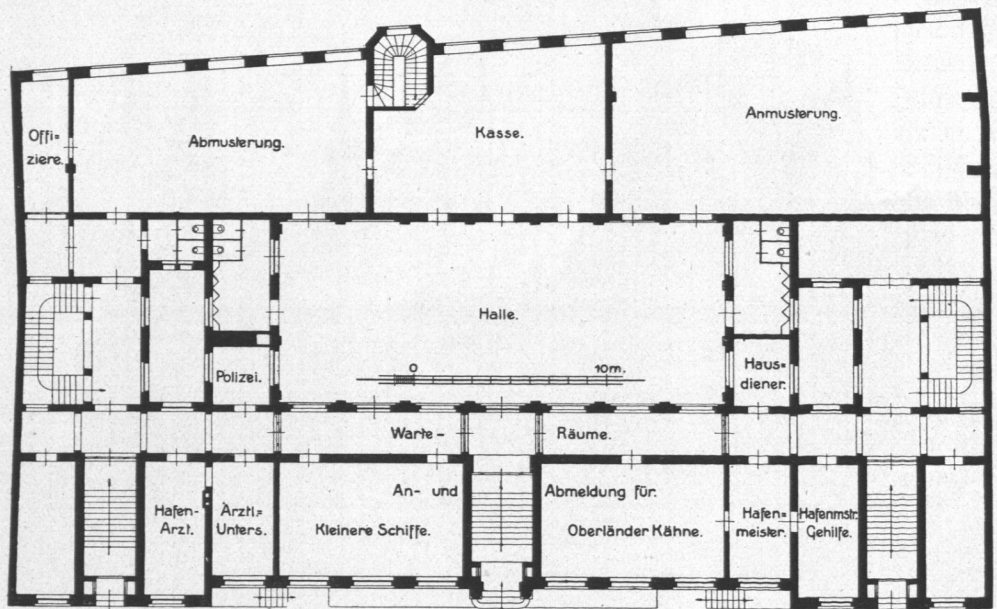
Marinegebäude, Grundriß, Erdgeschoß.
